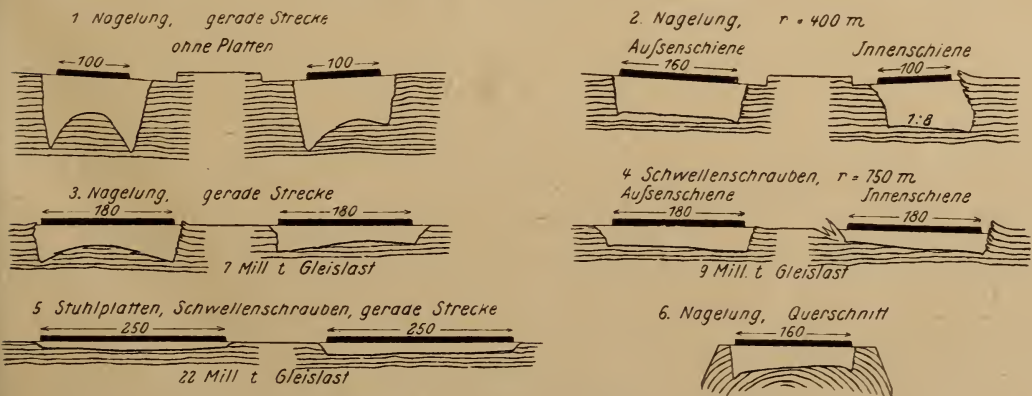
Verschleiß von kiefernen Schwellen. Längen 1:10, Höhen 1:2.
